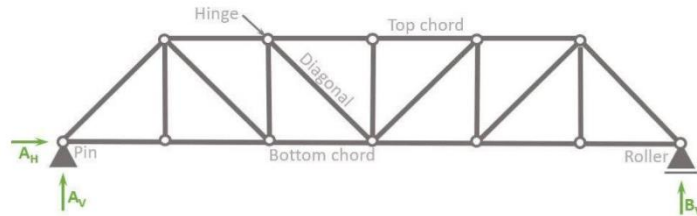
Estructura articulada tipo Pratt. Fuente: <https://www.structuralbasics.com/pratt-truss/>
